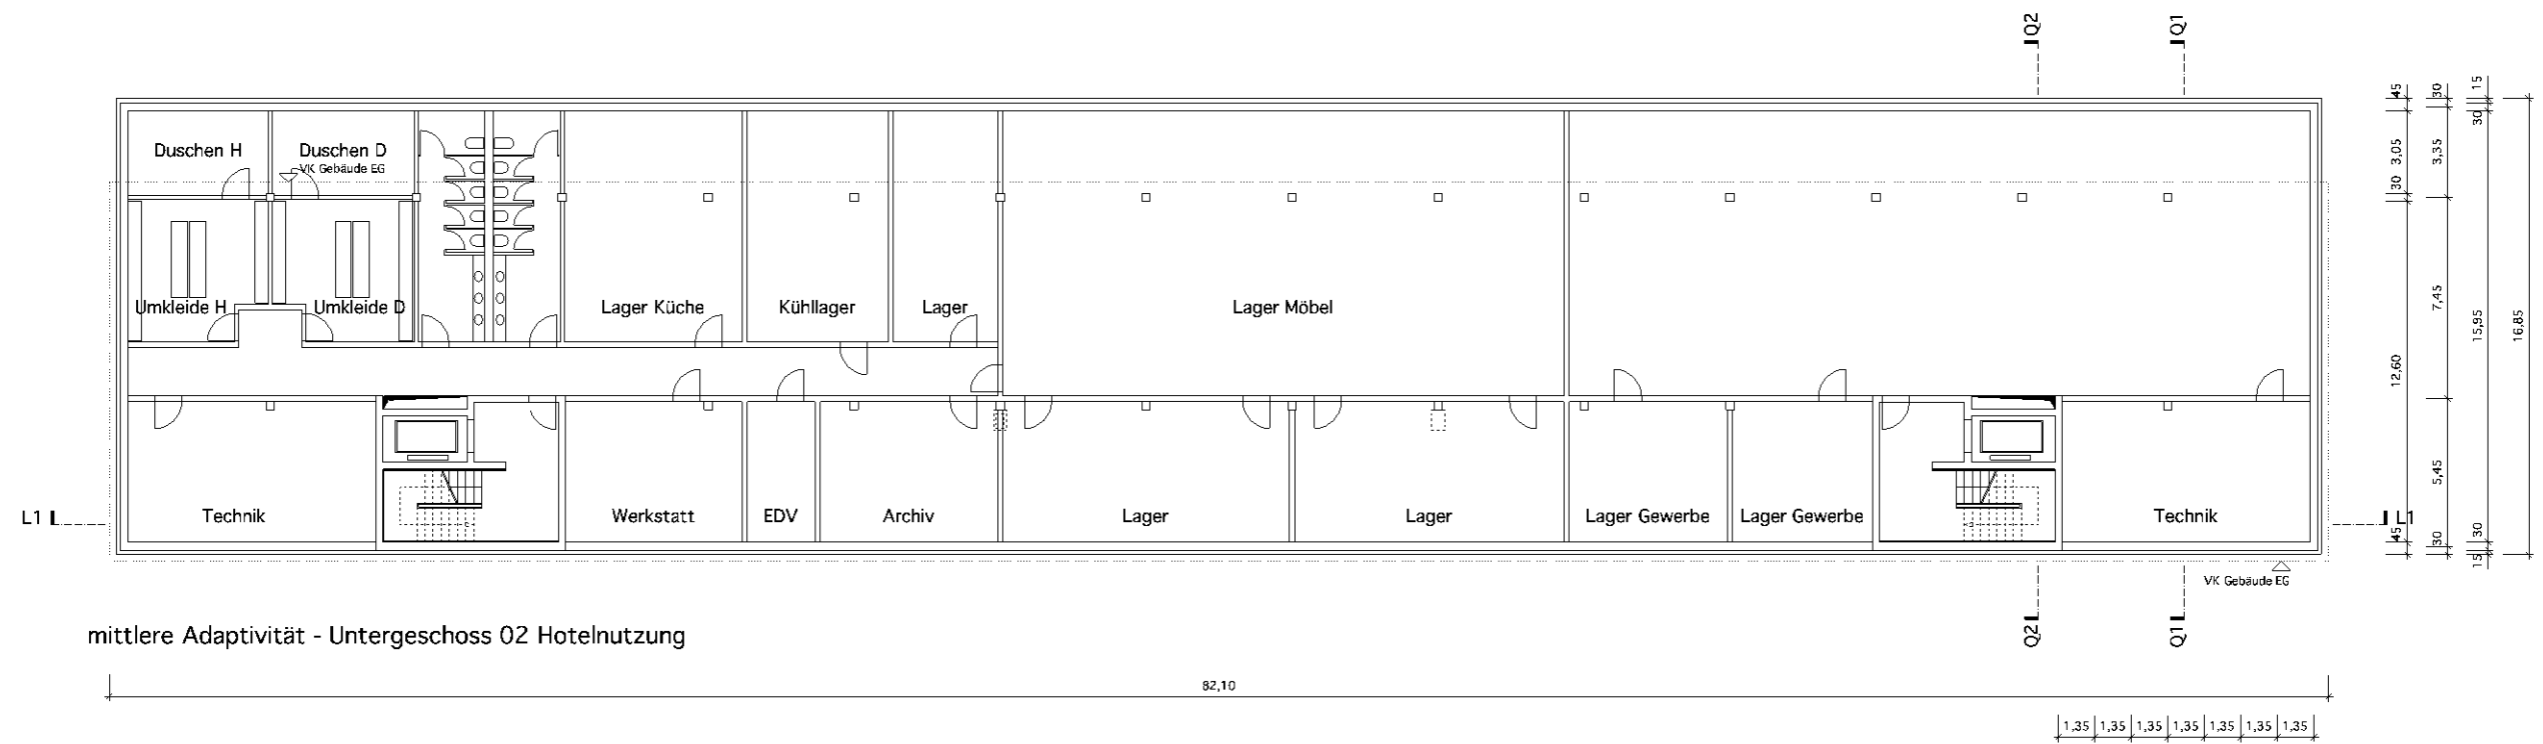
Grundriss Untergeschoss 01 des Referenzgebäudes „mittlere Adaptivität“ für eine Hotelnutzung
